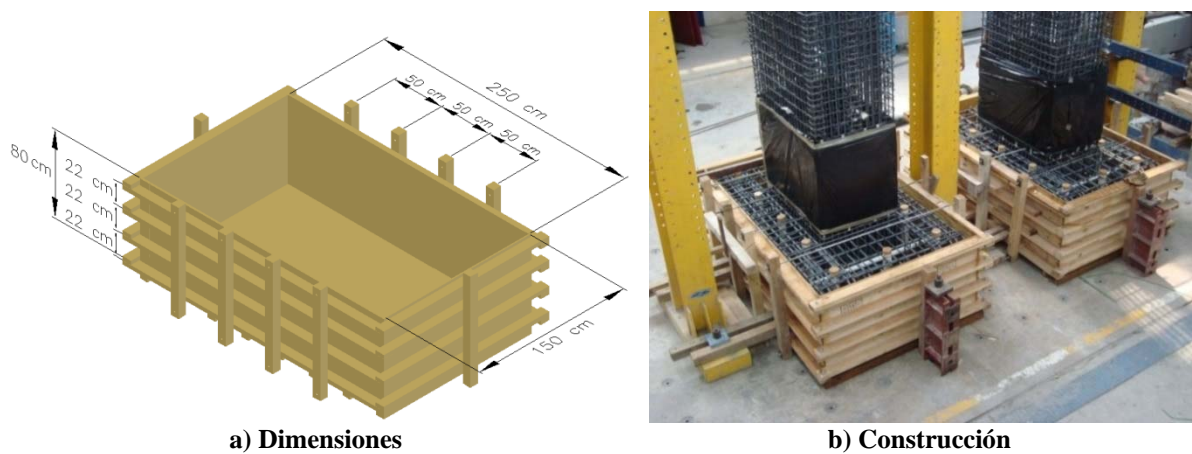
Armado de los paneles laterales de la cimbra para la zapata
